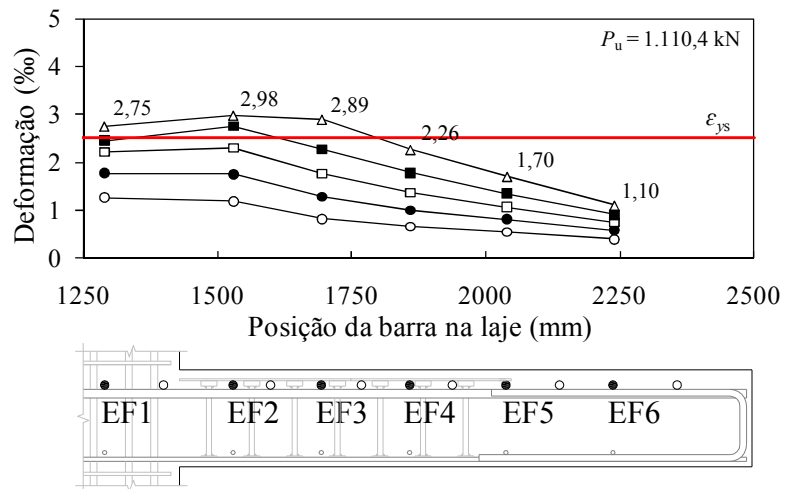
Deformações na armaduras de flexão da laje LC07
